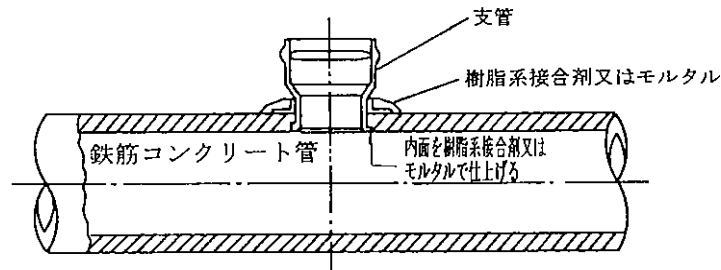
鉄筋コンクリート管及び陶管に対する接合
